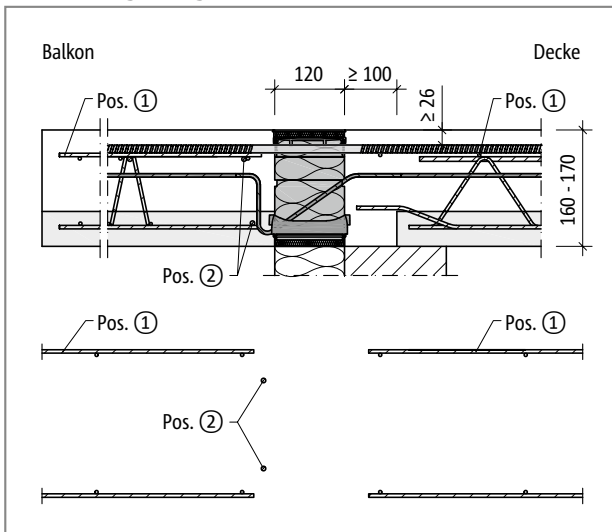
Schöck Isokorb® CXT Typ K-F: Bauseitige Bewehrung bei Balkonplattendicke h = 160 - 170 mm
